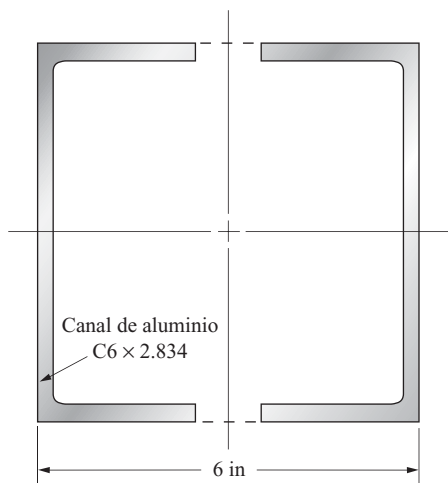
Sección transversal de columna compuesta del problema 11-14.
